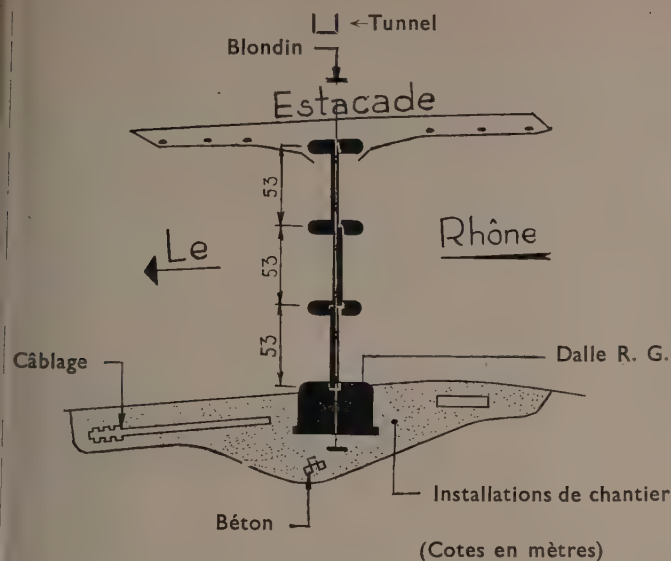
Schéma de l'installation de chantier de construction du pont.
